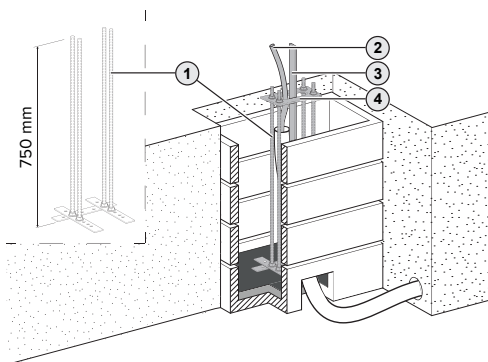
Inserire il set di montaggio per fondazione insieme alla piastra di fondazione (esempio: AMEDIO)
